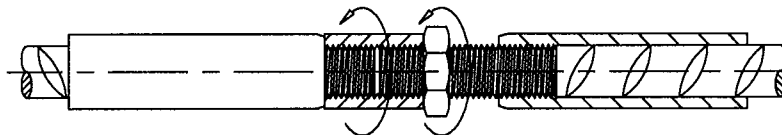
POSITIONSVERBINDUNG (PI) (Alternativ)
